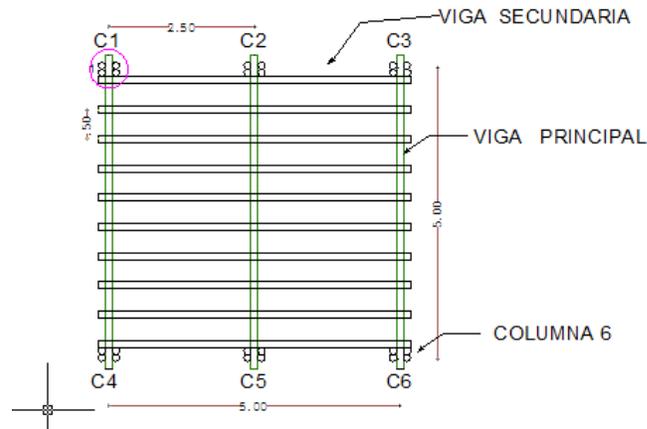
VISTA EN PLANTA SEGUNDO PISO.
